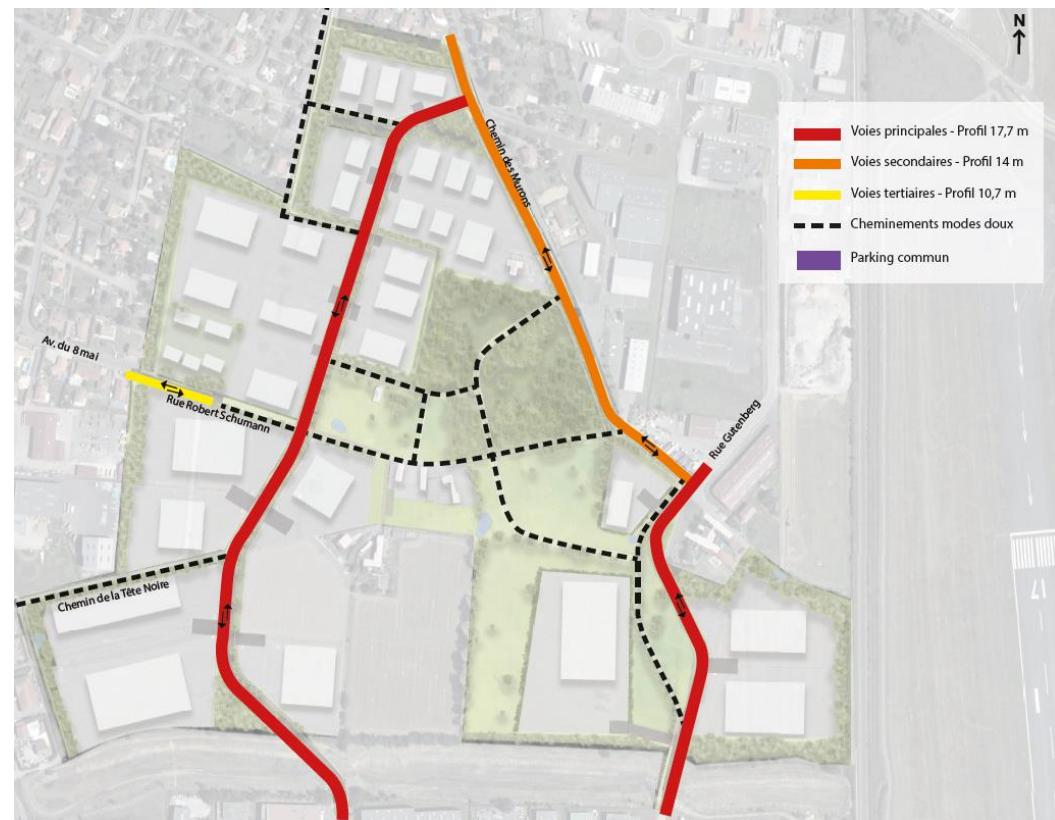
Plan de la future trame viaire (AVP, 2023)
